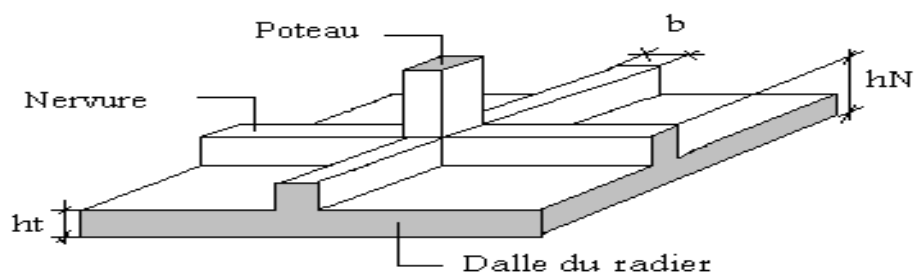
Disposition des nervures par rapport au radier et aux poteaux.
